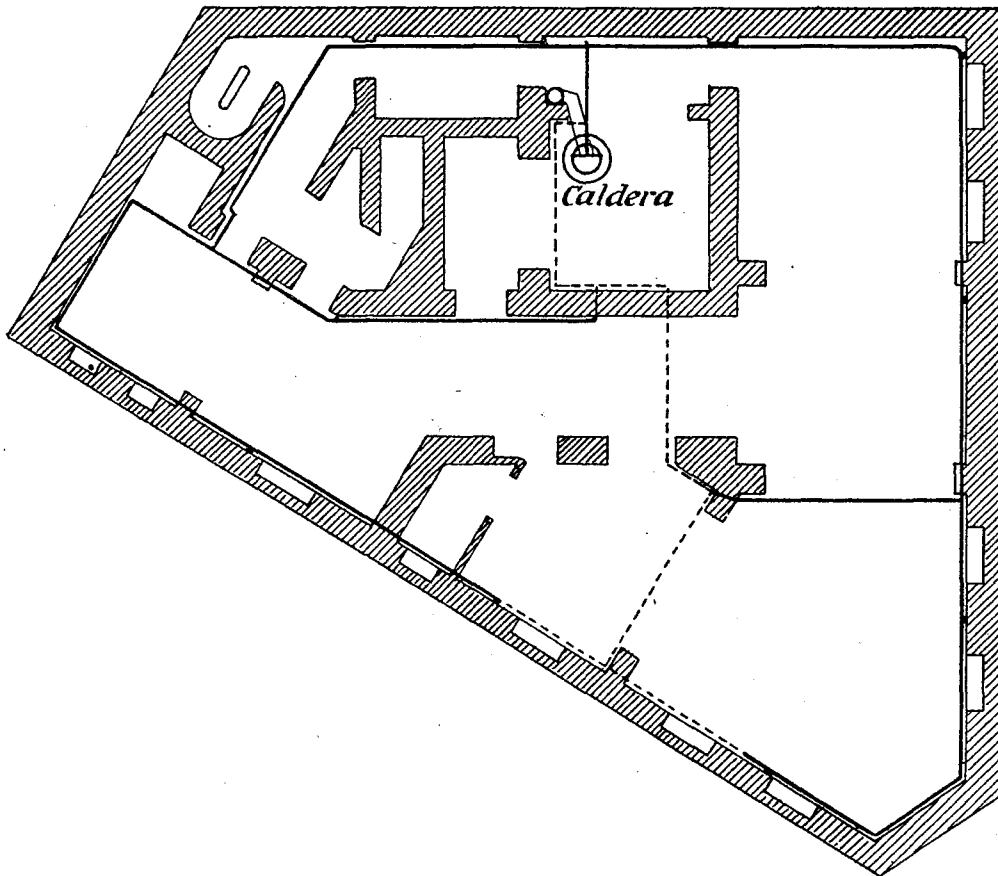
Planta de un edificio, con calefacción por vapor a baja presión.
